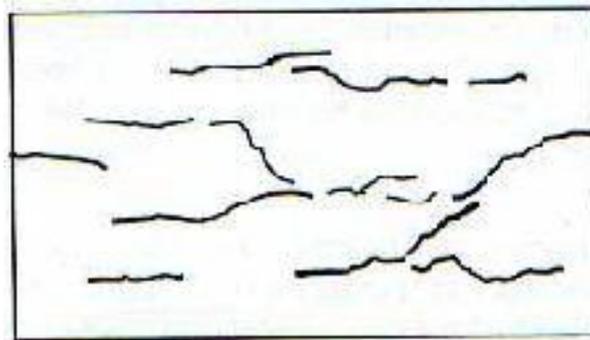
Fissuras de retração plástica do concreto. Fonte: RIPPER, 1996
